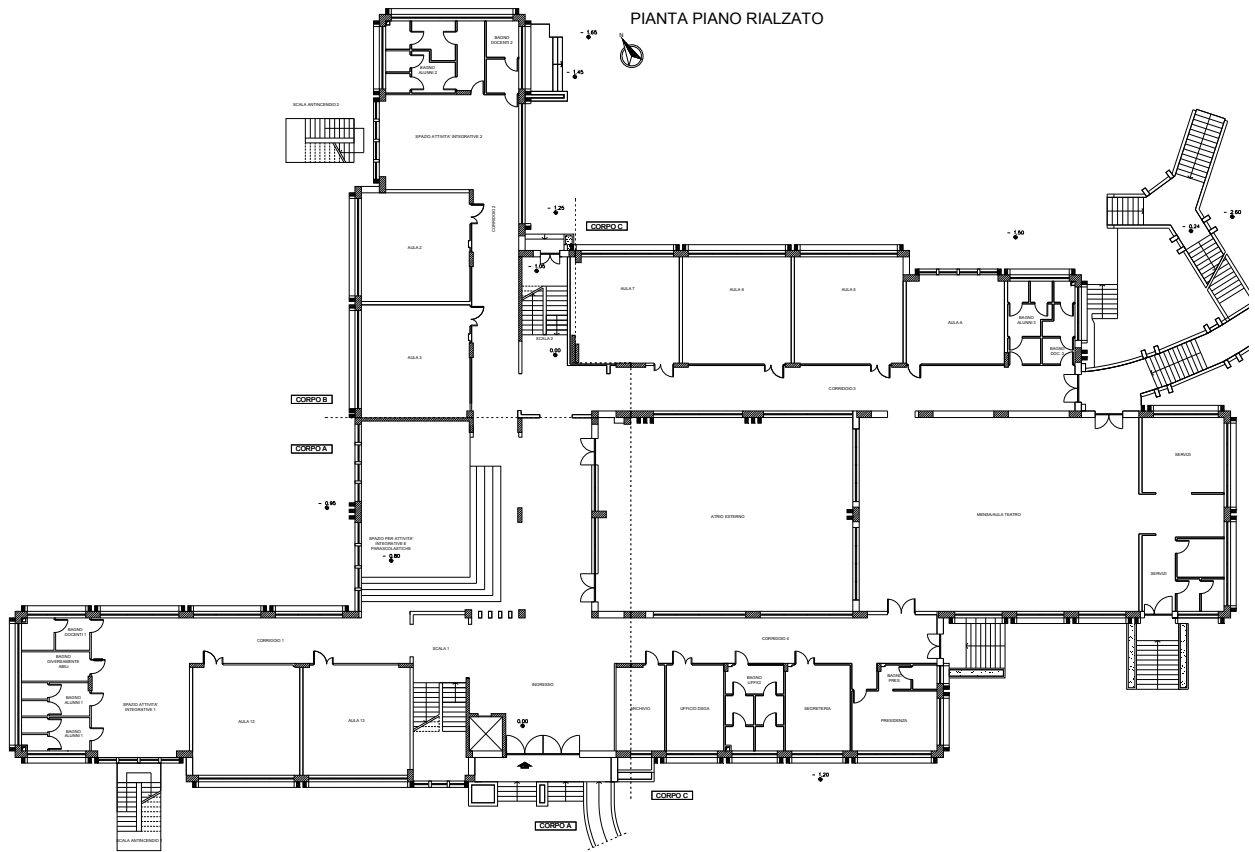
Pianta Piano Rialzato – Stato Futuro
